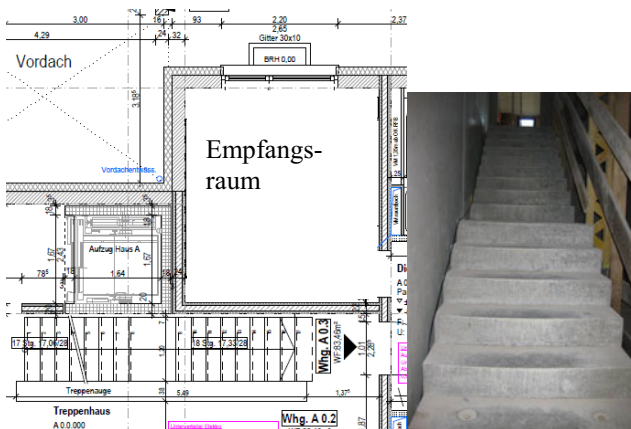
Grundrissituation und Treppenlauf am Bau
